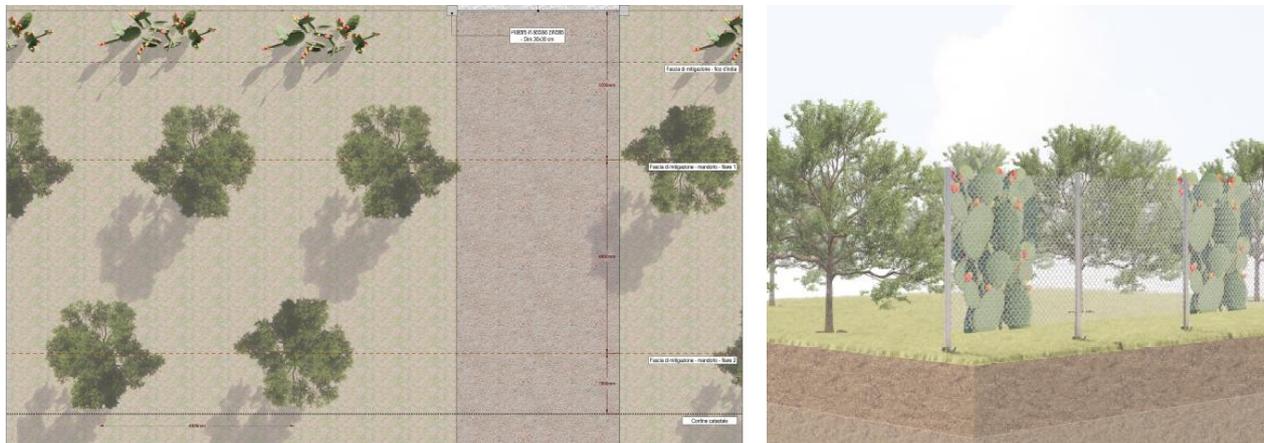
Pianta e spaccato assonometrico fascia di mitigazione
